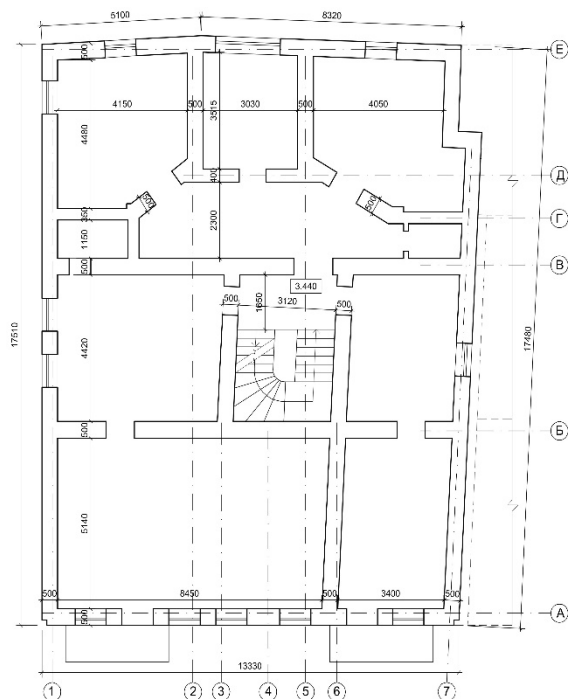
План 2-го поверху будівлі, що обстежувалась
